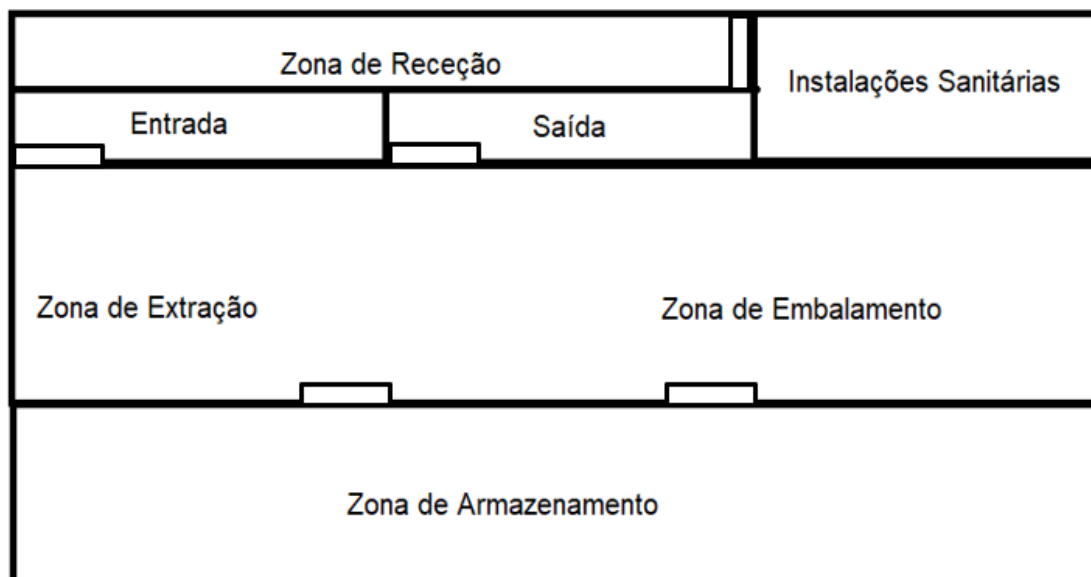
Planta da Unidade de Produção Primária (UPP), na escala de 1:100
